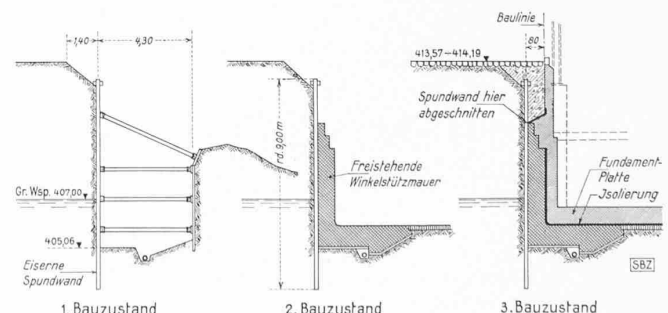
Bauvorgang beim Betonieren der Umfassungswände. — 1:300
